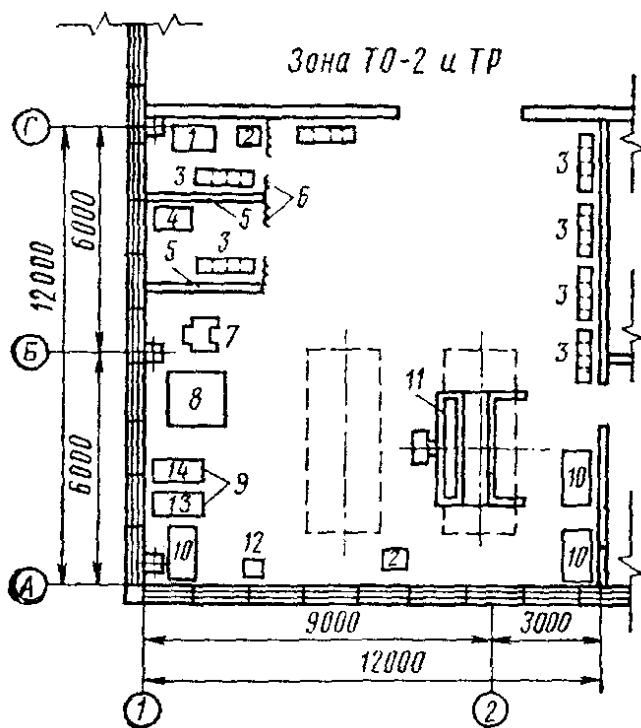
Технологічне планування кузовного відділення (типовий проект на АТП на 325 легкових автомобілів-таксі): 1 — стіл для зварювальних робіт; 2 — трансформатор; 3 — стелаж; 4 — стіл для зварювальних робіт; 5 — екран металевий; 6 — брезентова штора; 7 — верстак точильний; 8 — зиг-машина; 9 — підставка під обладнання; 10 — верстак слюсарний; 11 — перекидач автомобілів (набік); 12 — ногиці ручні; 13 — верстак настільний свердлильний; 14 — прес
